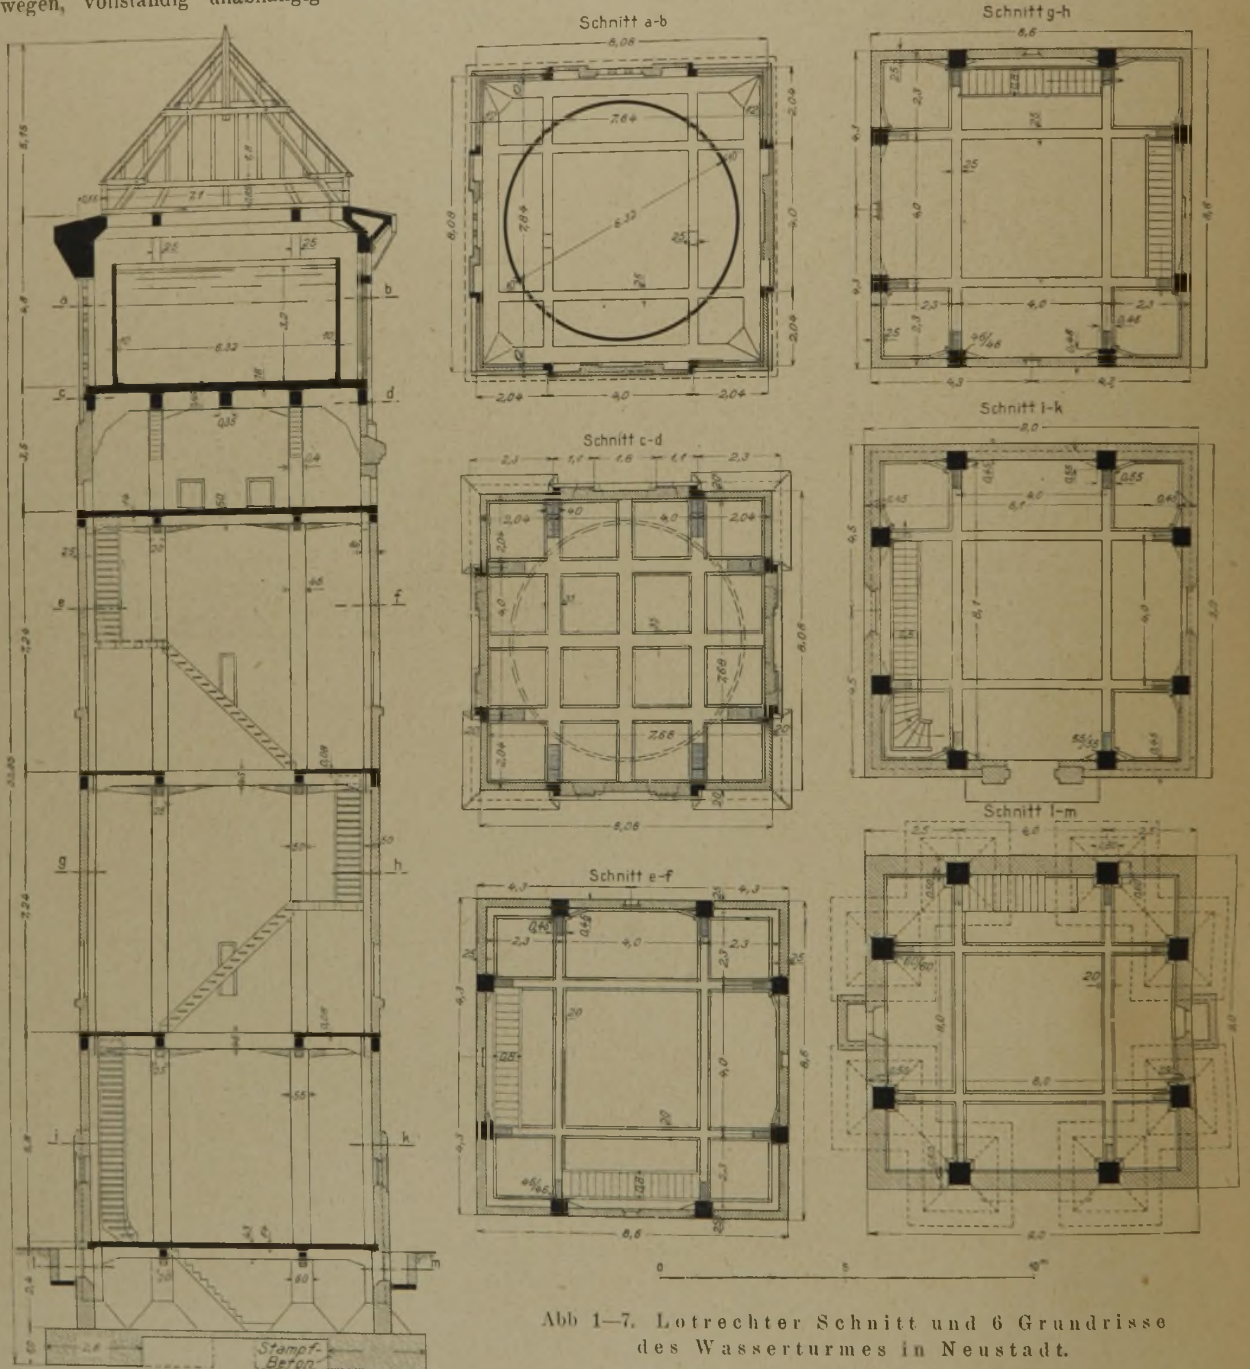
Lotrechter Schnitt und 6 Grundrisse des Wasserturmes in Neustadt.
